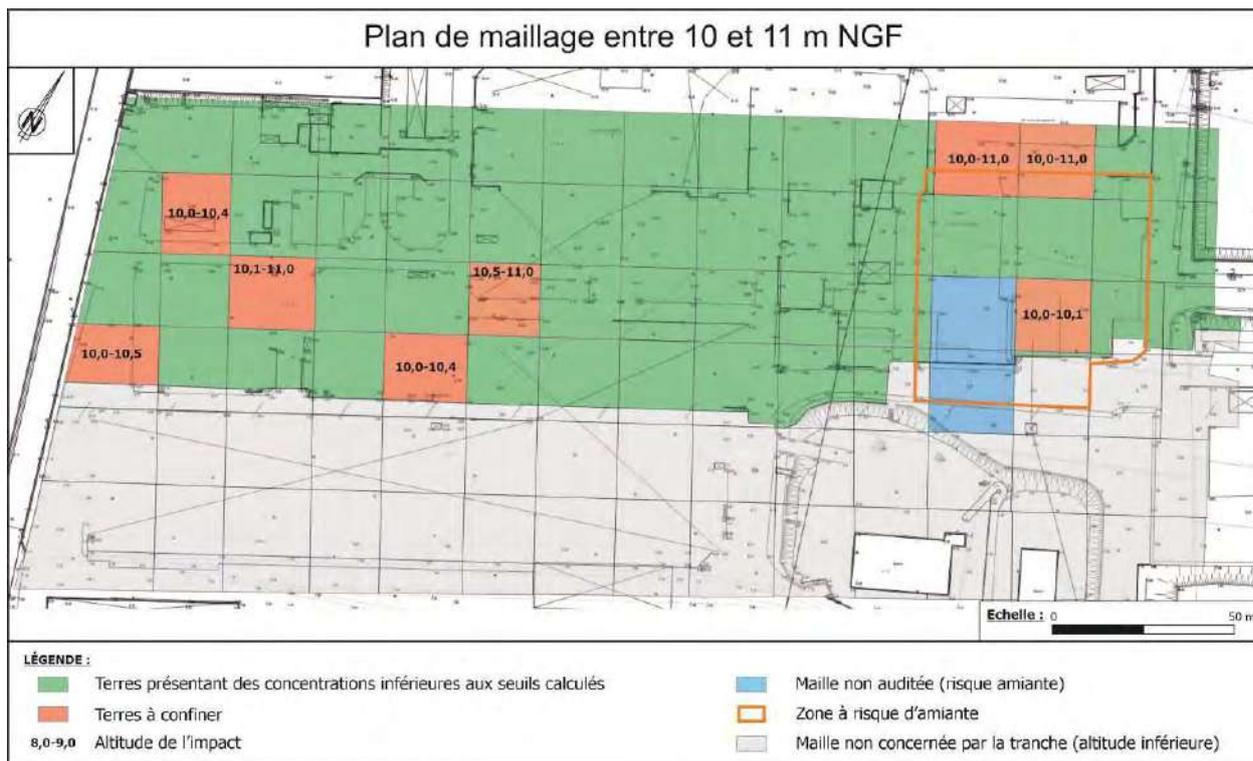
Plan de maillage entre 10 et 11 m NGF
